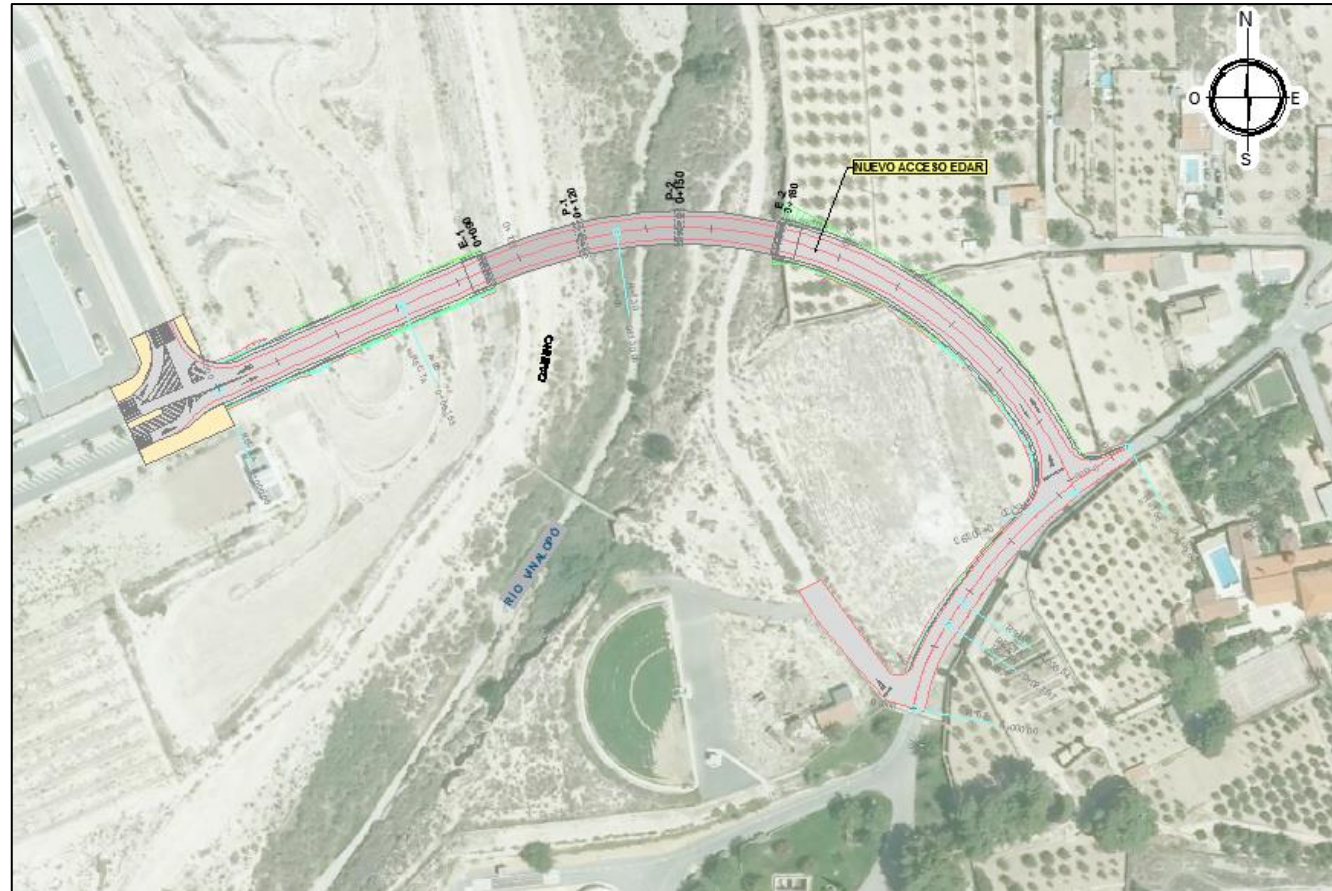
EDAR Valle del Vinalopó. Planta General del vial de nuevo acceso a la EDAR desarrollado en el proyecto.
